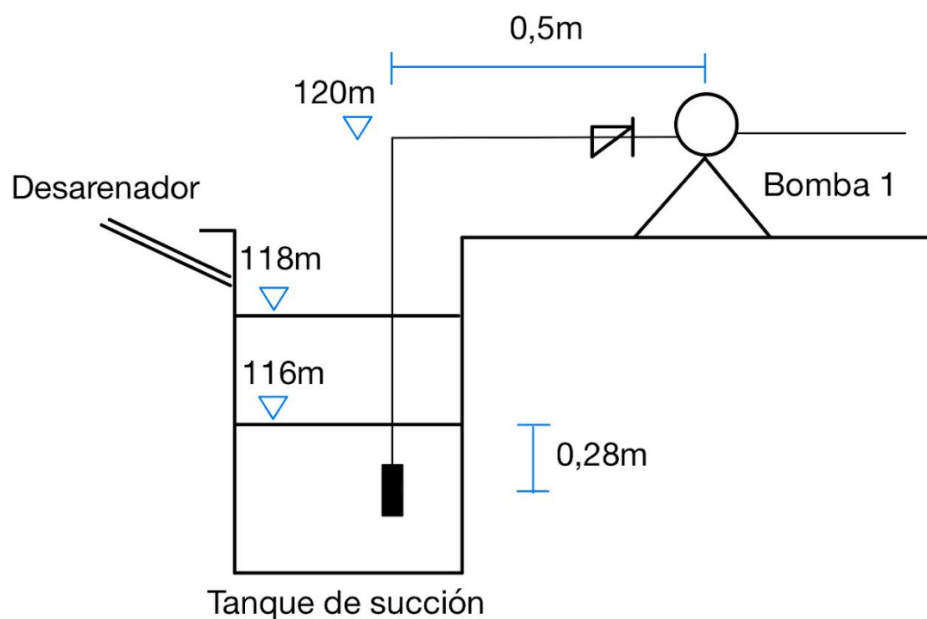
Detalle de la tubería de succión. Fuente: Elaboración propia
